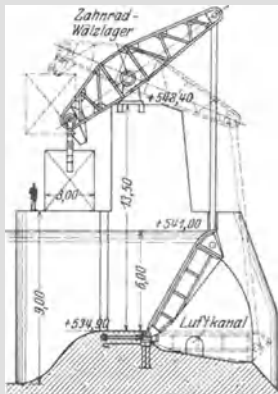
Stauklappe mit Obergewicht am Hebel.
